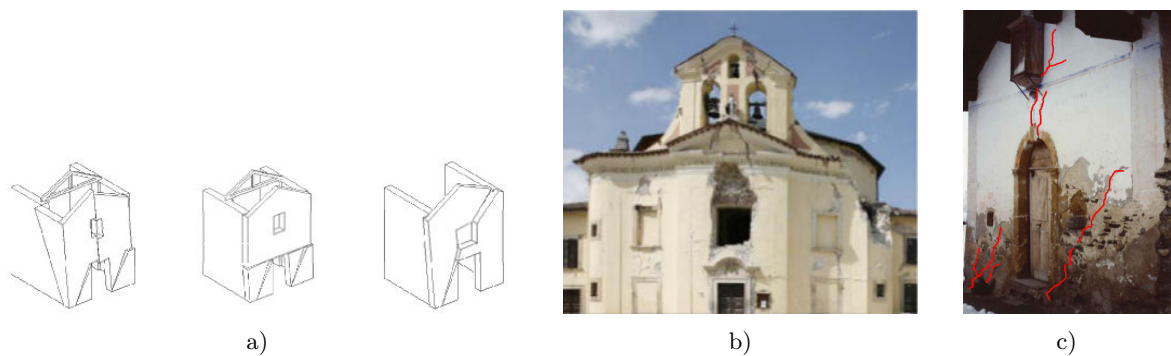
Rotation de la façade dans son plan. a) Mécanismes, (Papa et Pasquale, 2013). b) Fissuration et effondrement partiel de la façade de l'église dell'Immacolata, Paganica. c) Fissure verticale dans l'axe de la porte et fissures des panneaux latéraux, Boudin, Arèches
